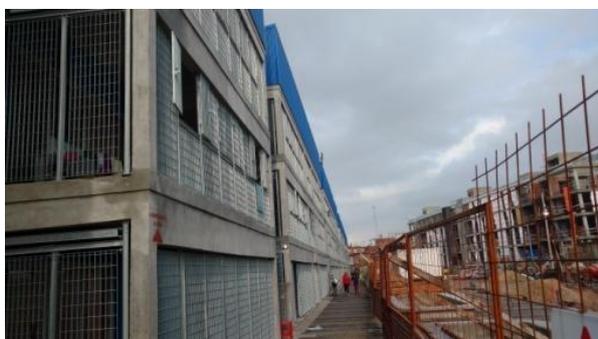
Vista del sistema de fachadas del plan piloto de mejoramiento.
